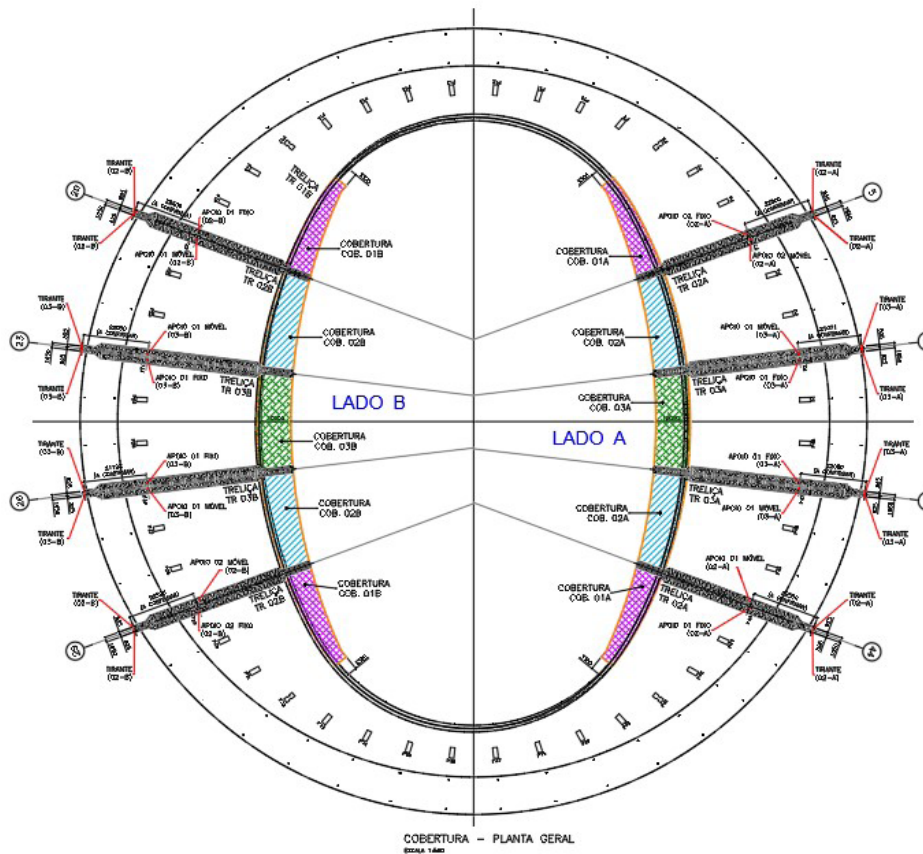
Vista em Planta das Treliças Metálicas sobre a Cobertura.
